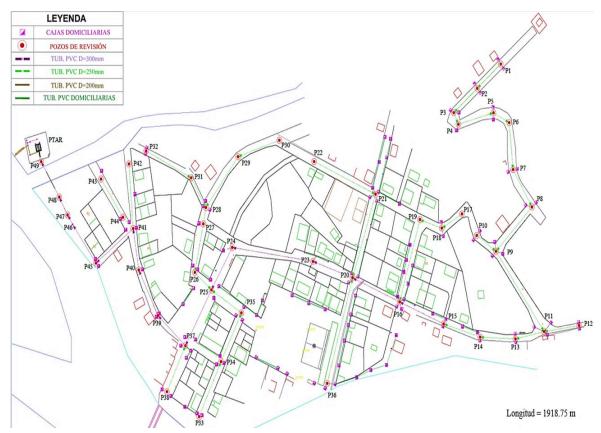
Trazado de la red de alcantarillado sanitario (propuesta de ampliación)
